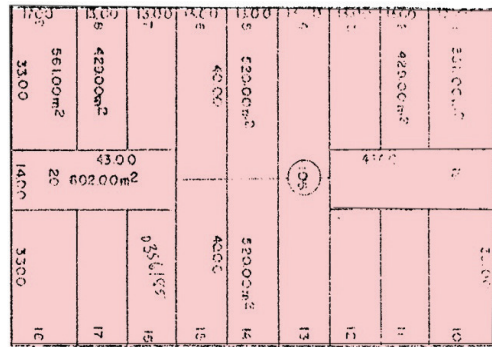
Planta da quadra do Conjunto Cajazeiras (1980).
